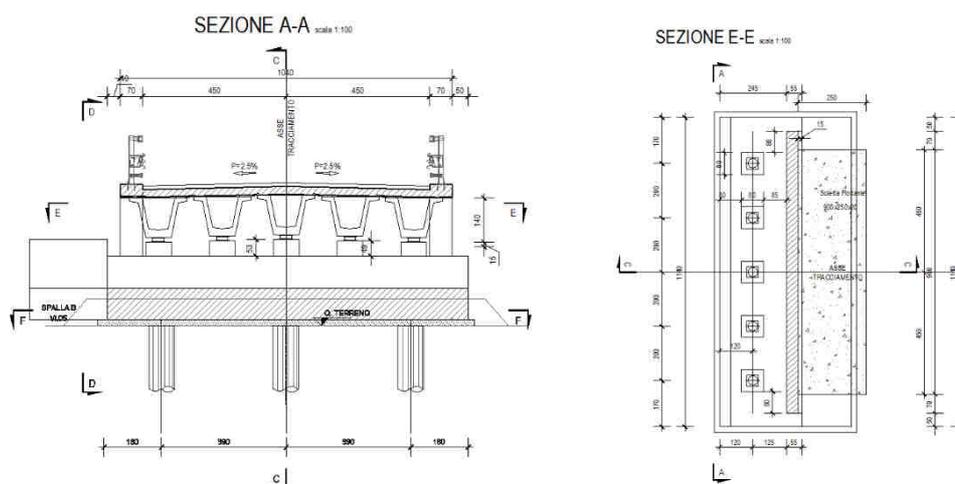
Spalla B prospetto e pianta - Ponte Rio Cungianus su viabilità S08
